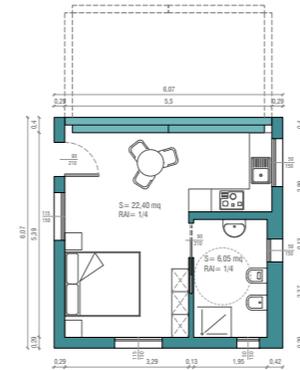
Pianta modulo singolo con pareti chiuse - variante 2. Scala 1:200
